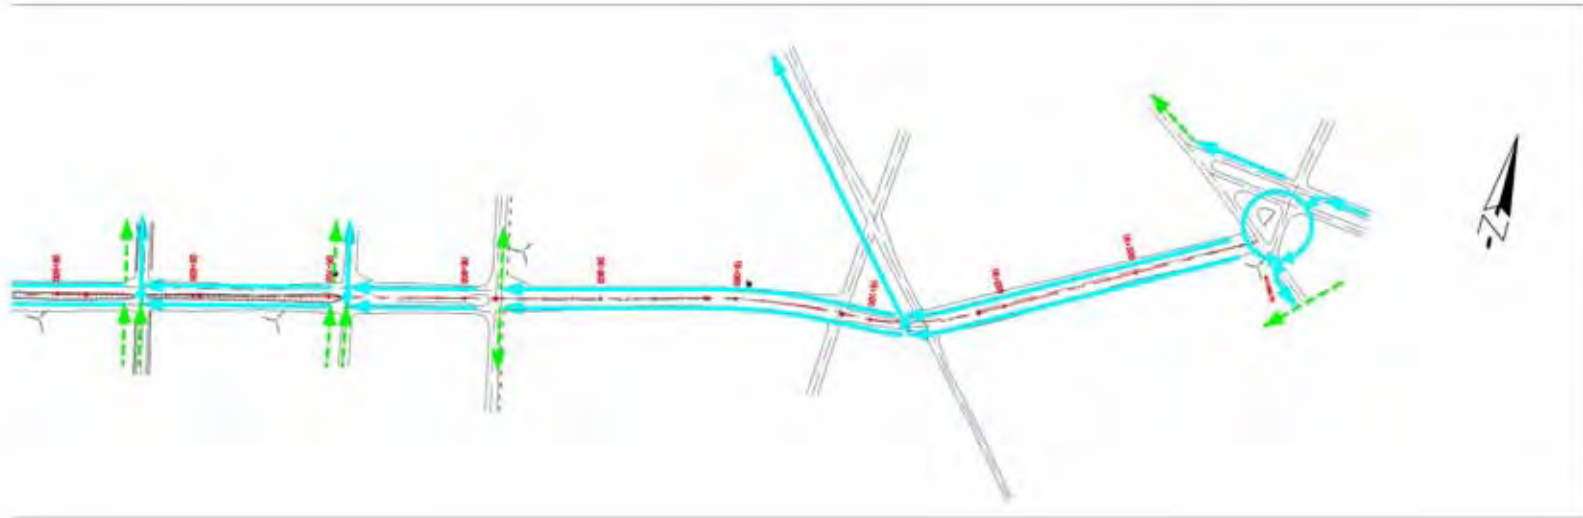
(2) : Plan de réseau de drainage des routes de projet (2/3)
